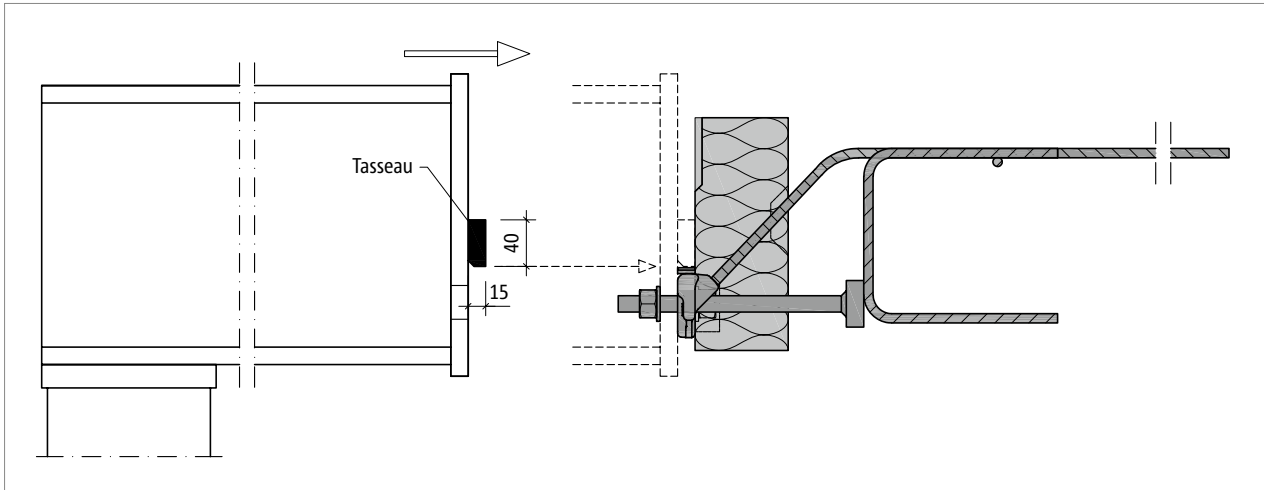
Schöck Isokorb® T type SQ : montage de la poutre en acier
